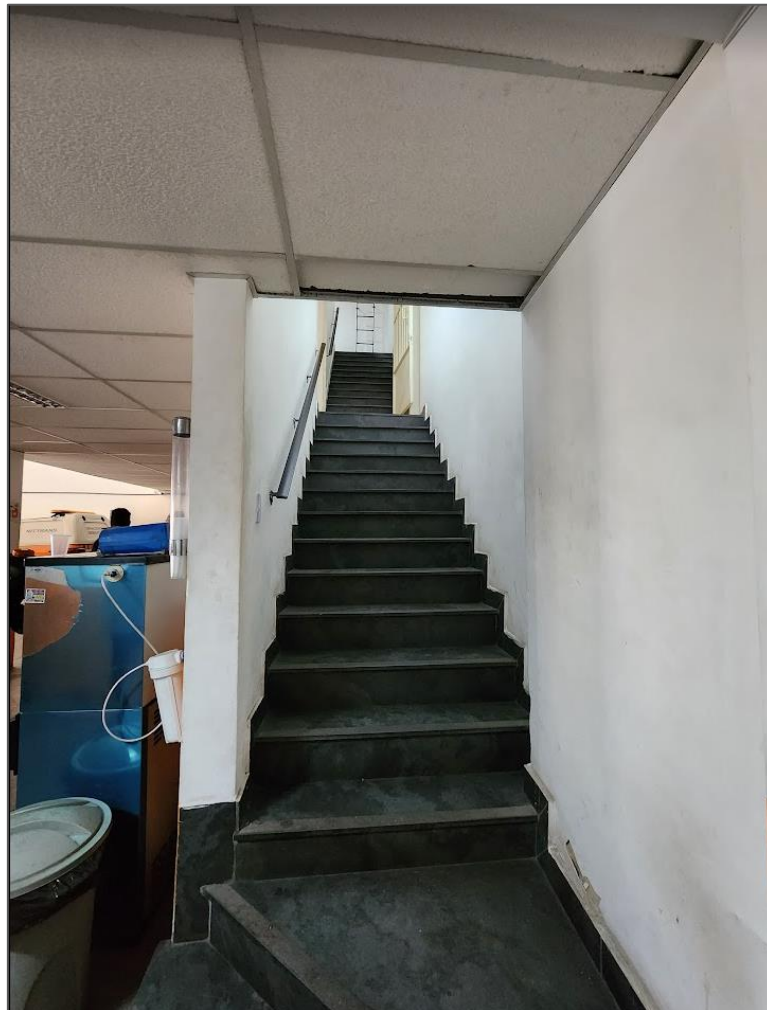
Escada de acesso ao mezanino e 02º pavimento.
